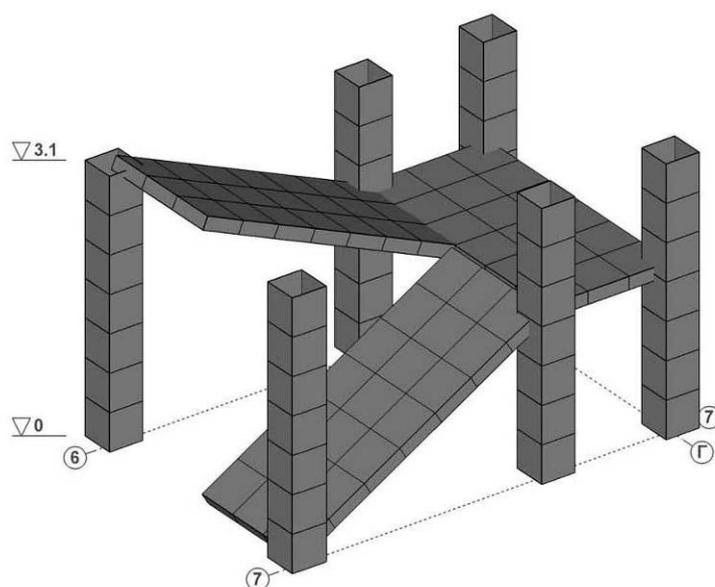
Фрагмент расчетной схемы, моделирующий лестничную площадку и марши
